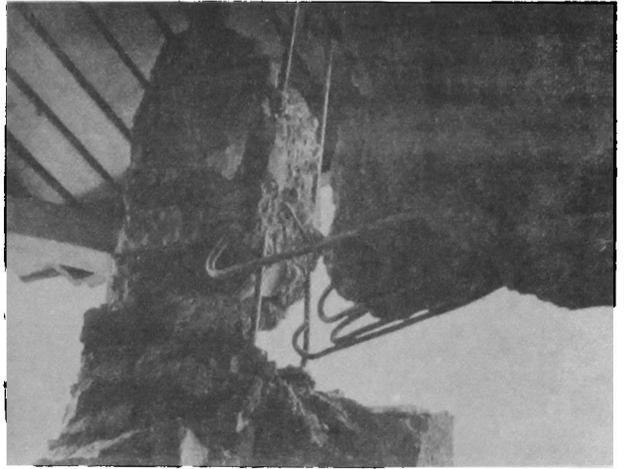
Conexión de dos cadenas y pilar en esquina. Casa de máquinas de Estación de El Volcán.
